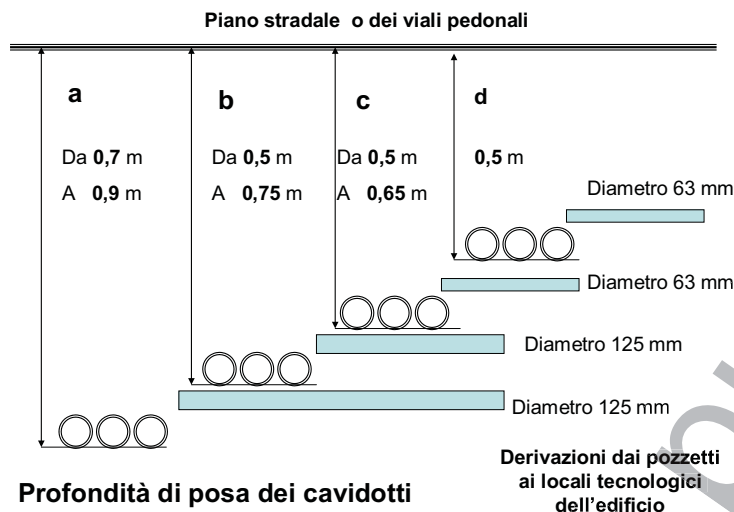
esempio di profondità di posa per più impianti sulle strade e/o viali all'interno della proprietà
